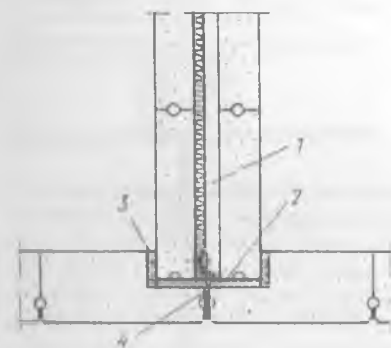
Соединение общей стены со специально шпунтованными наружными стеновыми плитами
